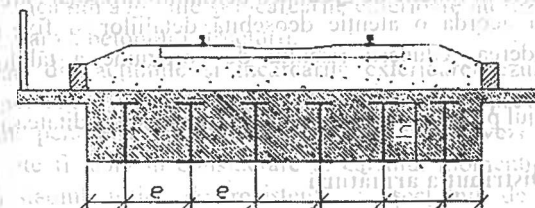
Schema secțiunii transversale pentru un tablier cu grinzi metalice înglobate în beton
